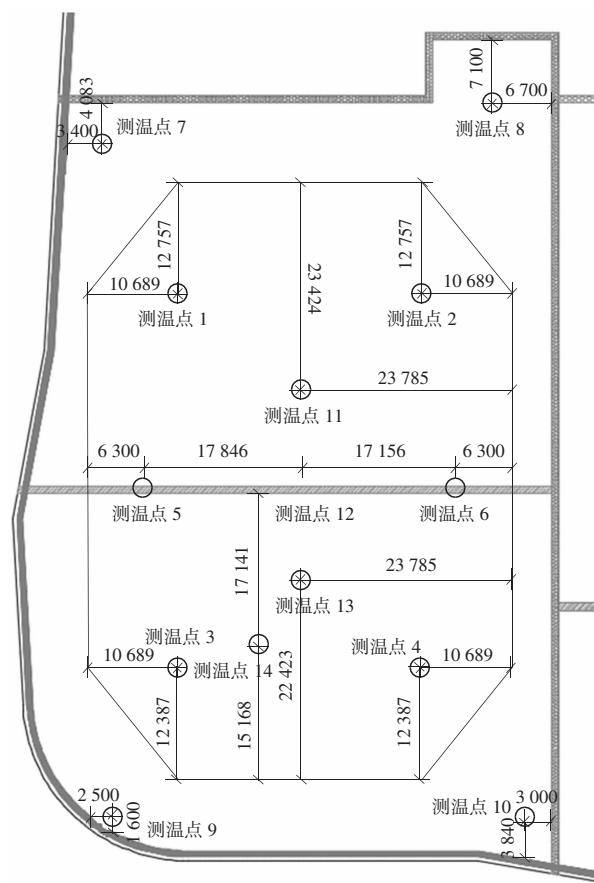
主塔楼底板及电梯基坑温度监测点平面布置示意图
